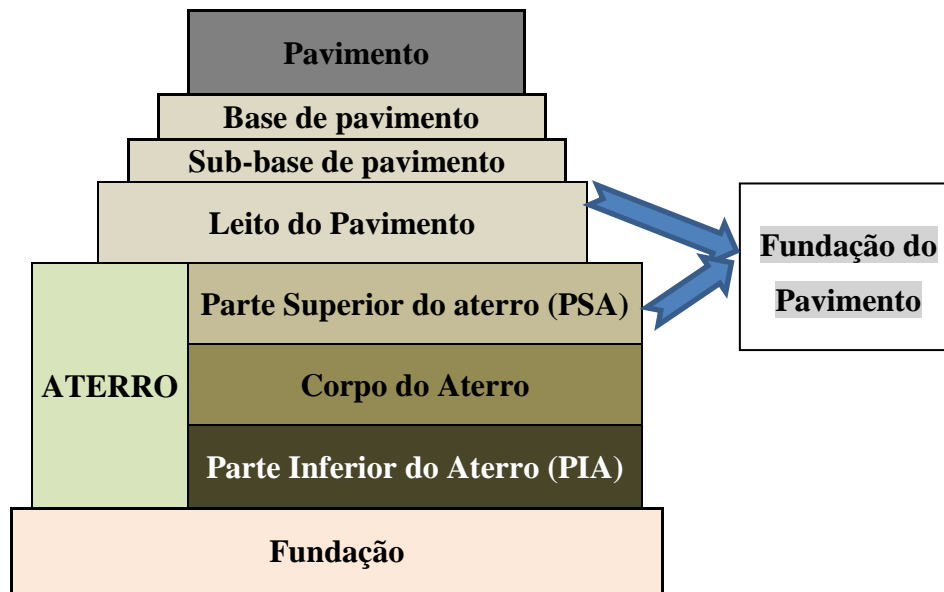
Estrutura genérica de pavimento tipo, em zona de aterro
